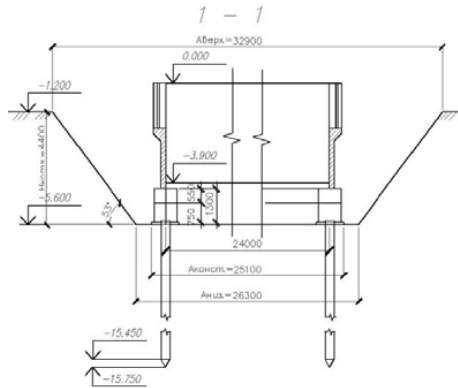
Разрез котлована с подвалом и свайным фундаментом
